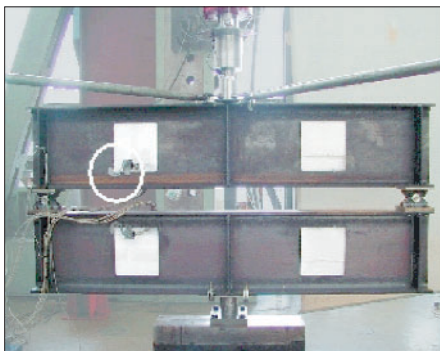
Versuchsaufbau mit zwei Ersatzbauwerken und Detailvergrößerungen Fensterecke
